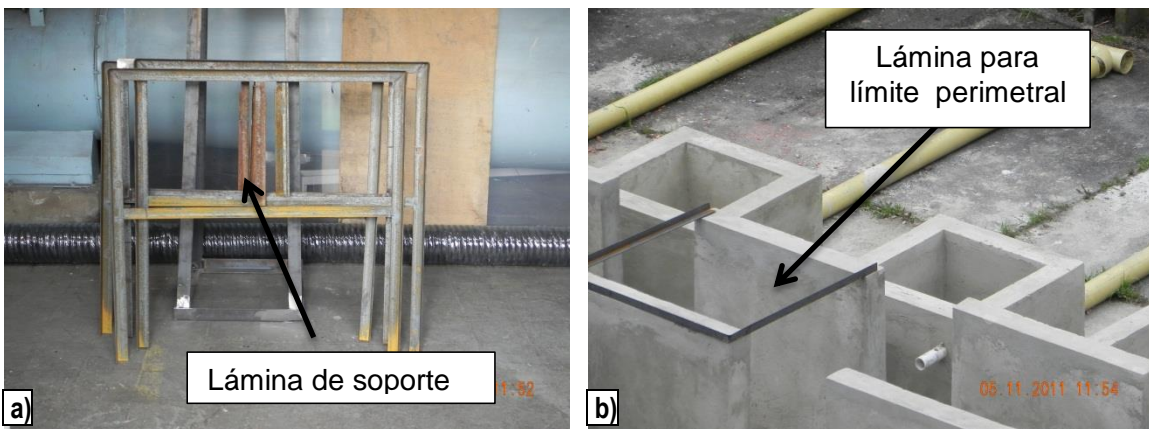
Instalación de la lámina metálica de soporte y para el límite perimetral.
